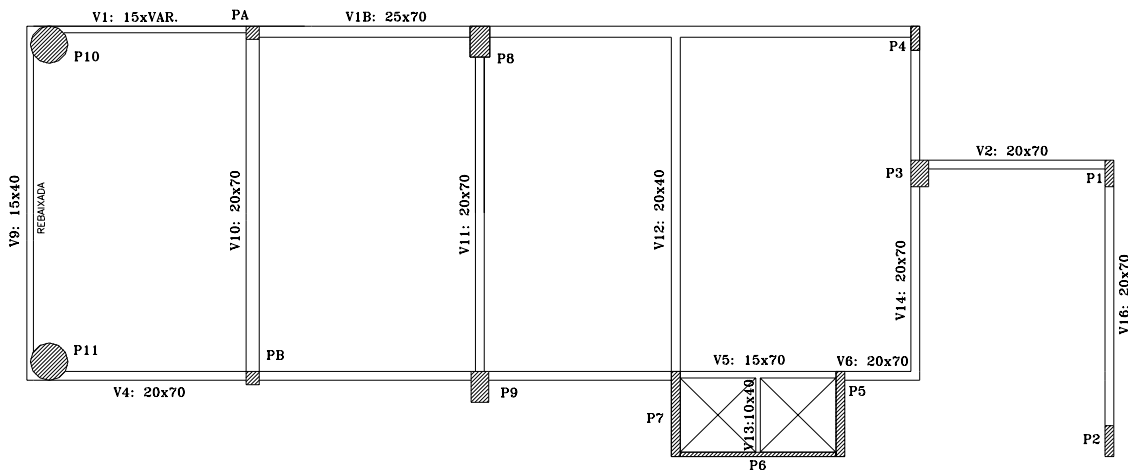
Pavimento térreo do edifício Tokio Center
